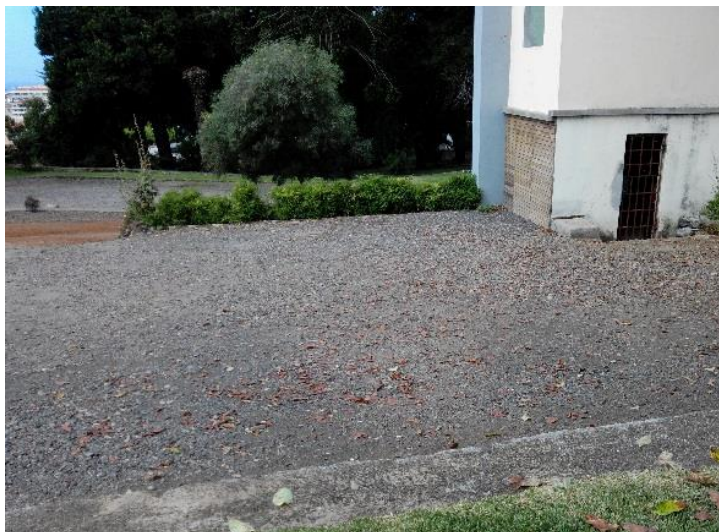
Área utilizada para a instalação dos pré-fabricados
